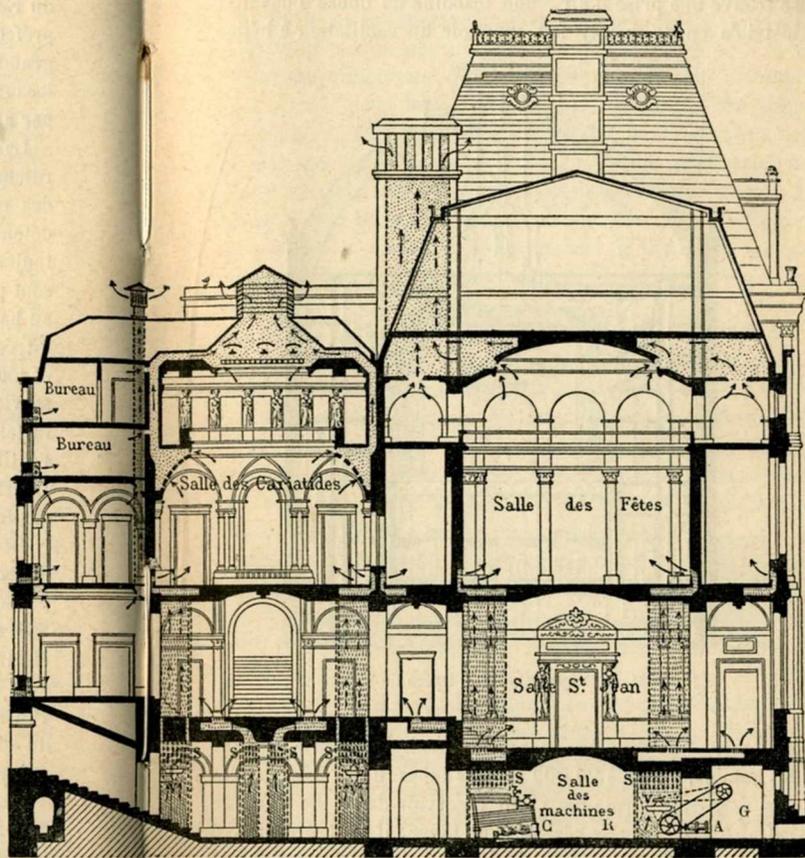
Hôtel de ville de Paris (coupe transversale, façade est).
